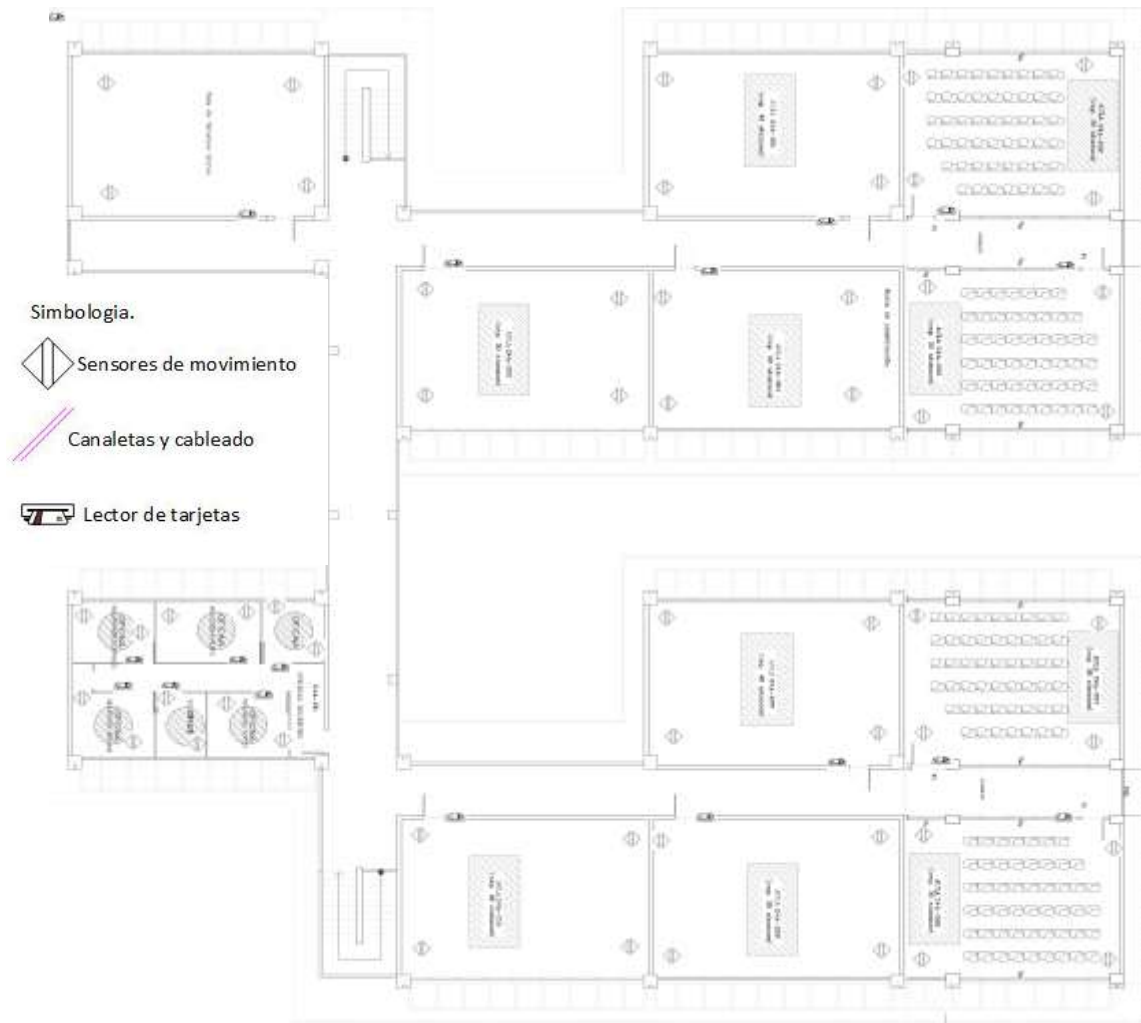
Diseño Estructural del Sistema del bloque 24A y B planta alta
